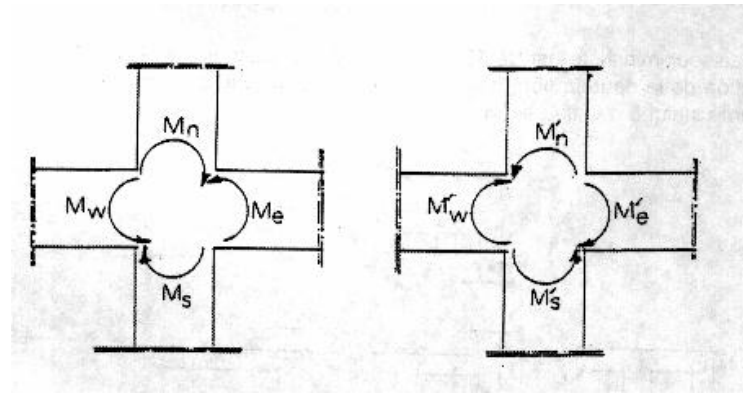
Dimensionnement d'un nœud poteau-poutre
